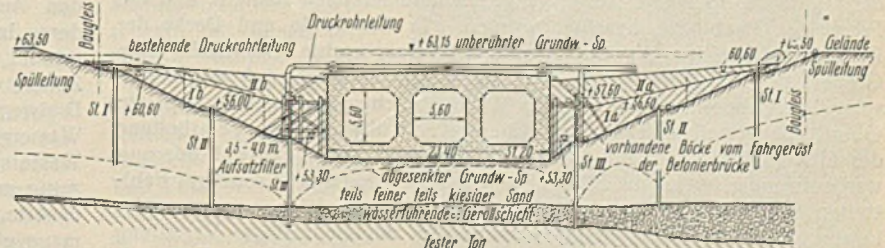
Querschnitt der Baugrube mit den drei Grundwasserstaffeln und den Hilfstaffeln für den Rückbau.
